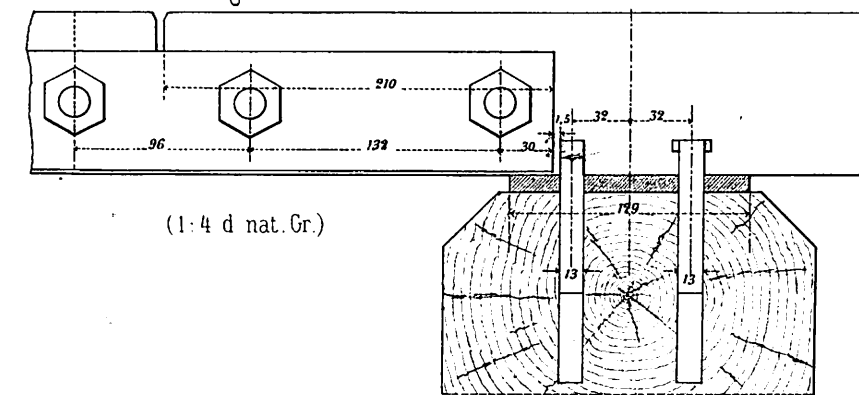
Grundriss des Schienenstosses (1:4 d. nat. Gr.)
